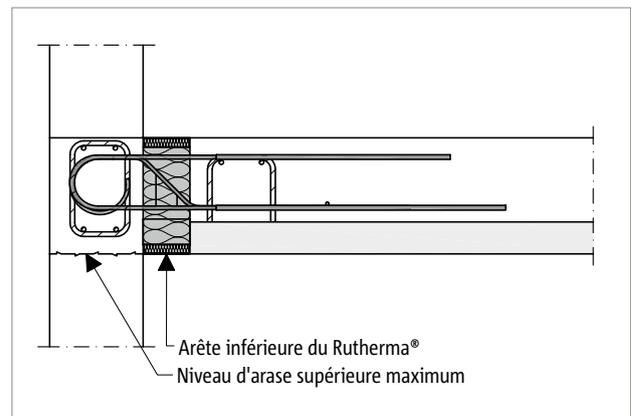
Schöck Rutherma® T type DF : plancher constitué de prédalles et façade en béton armé (valable également pour Schöck Rutherma® T type DF-S)
